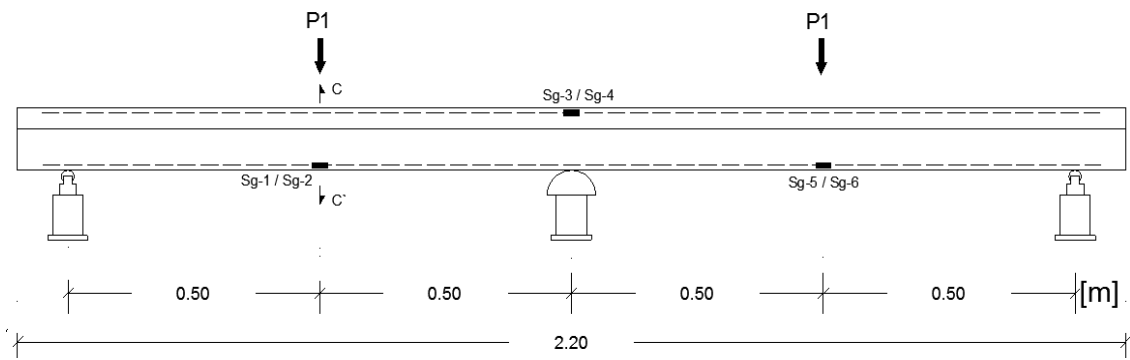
Plano de extensometria nas vigas com varões de GFRP
